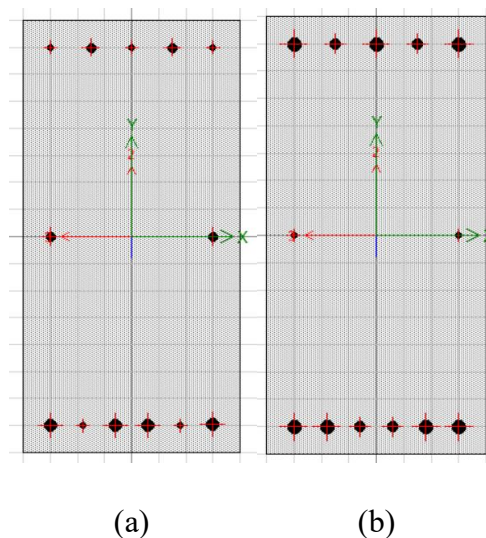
(a) Vigas del eje 1 y 6 con sección de 80x40cm. (b) Vigas desde el eje 2 hasta el 5 con sección de 80x40cm
